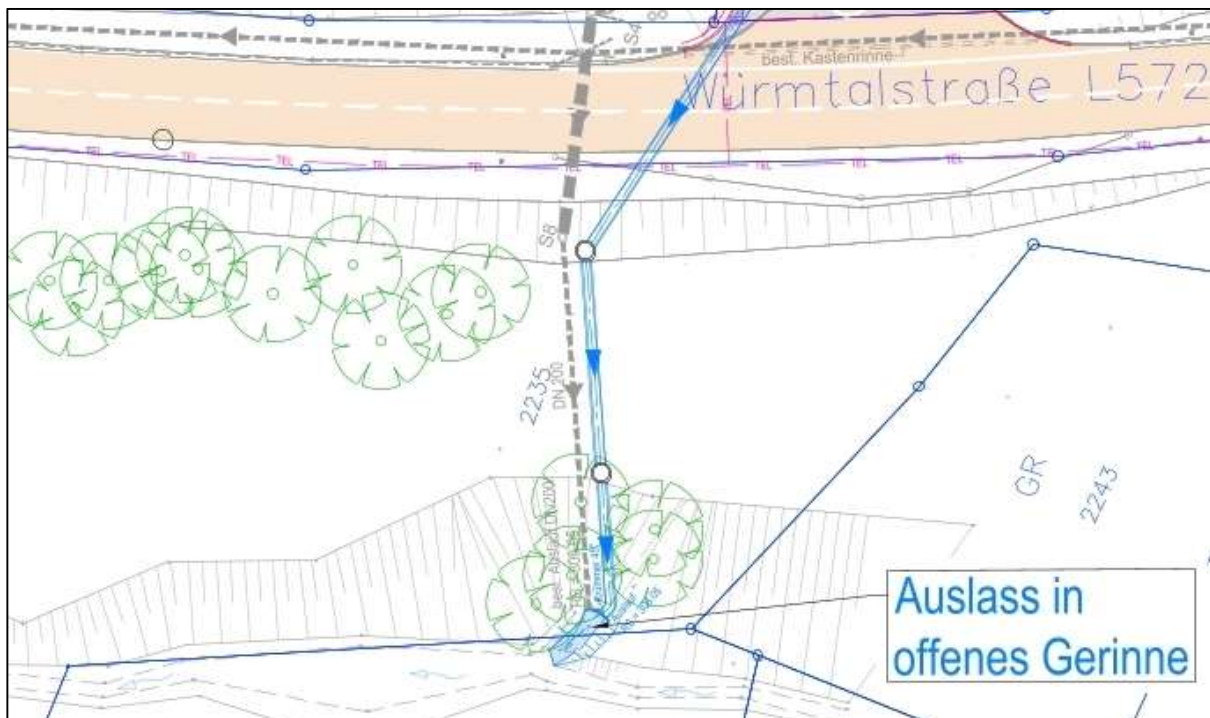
Lageplanauszug geplante Wassereinleitung
